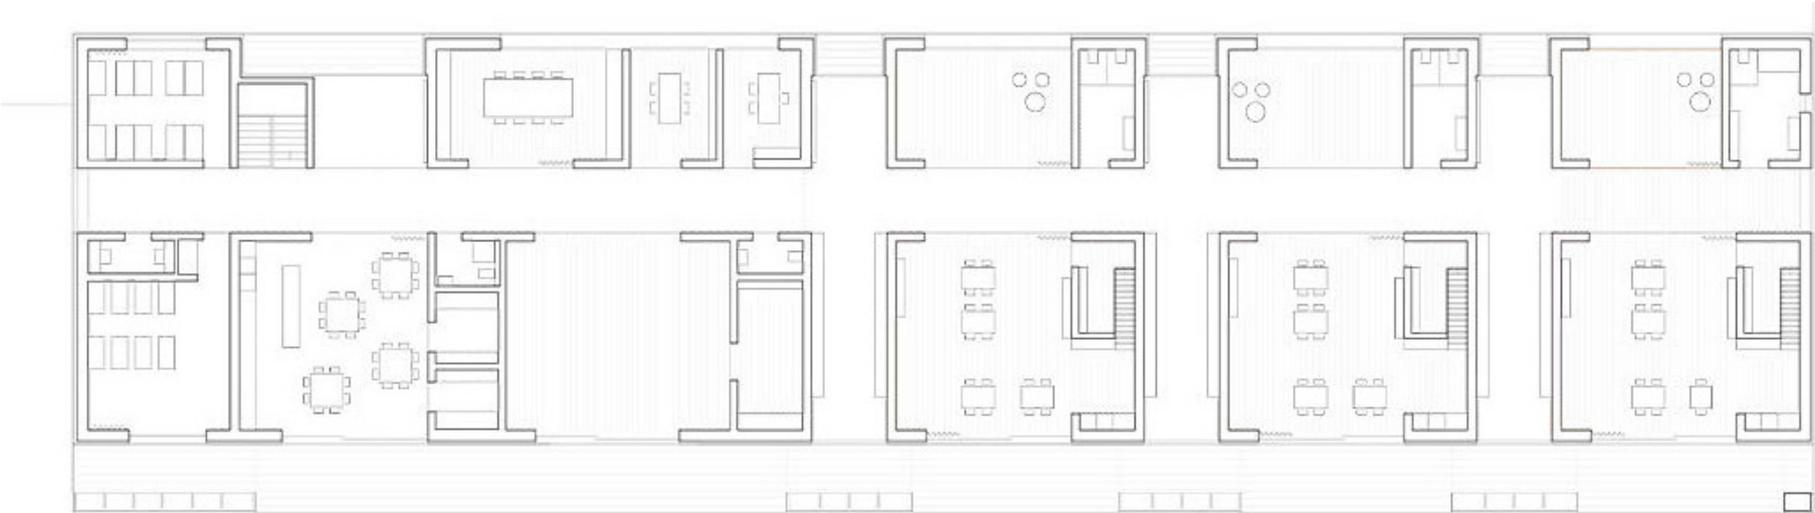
Kindergarten am Entenbach, Grundriss
